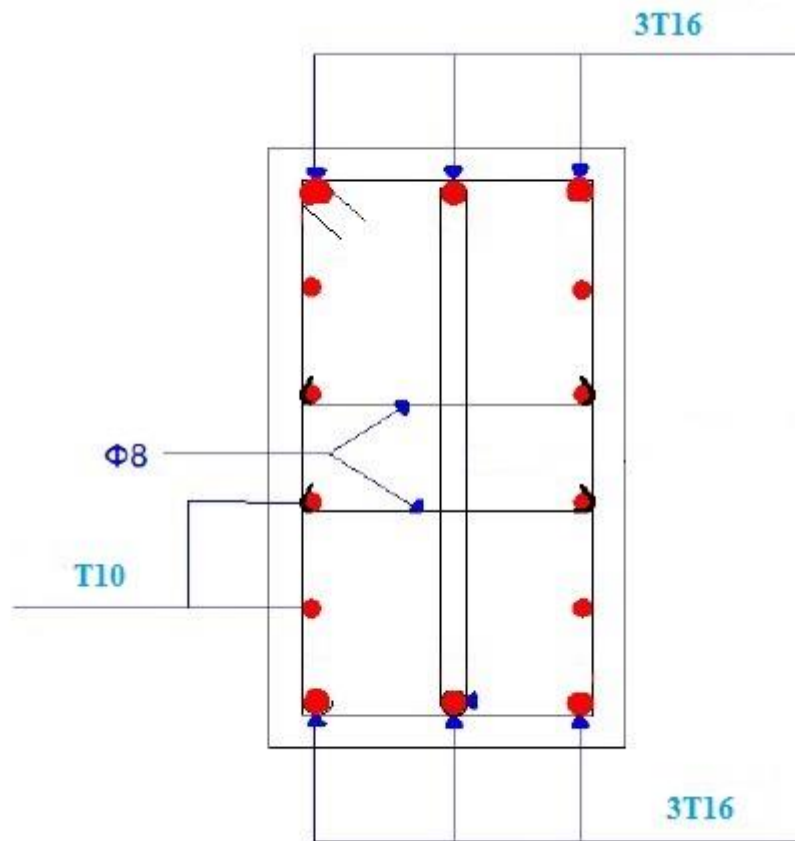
Plan de ferrailage de l'entretoise d'about
